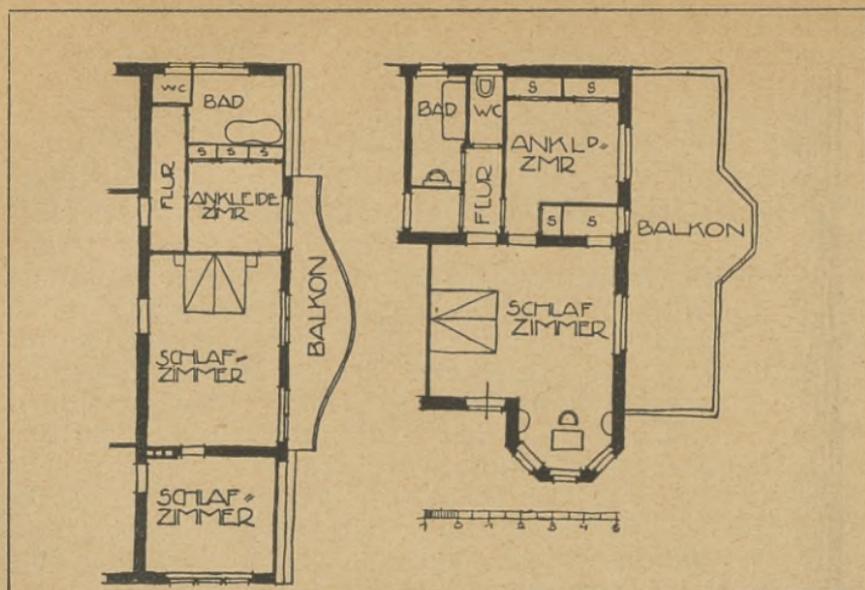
und 162. Lage des Schlafzimmers zum Ankleidezimmer und Bad
